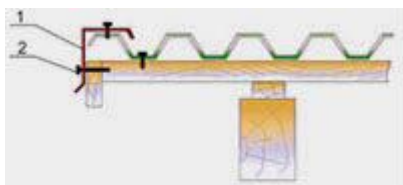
Поперечное примыкание ската к стене. Угловая планка при поперечном примыкании к стене крепится с шагом 200 - 300 мм и с нахлестом между планками 150 мм.
